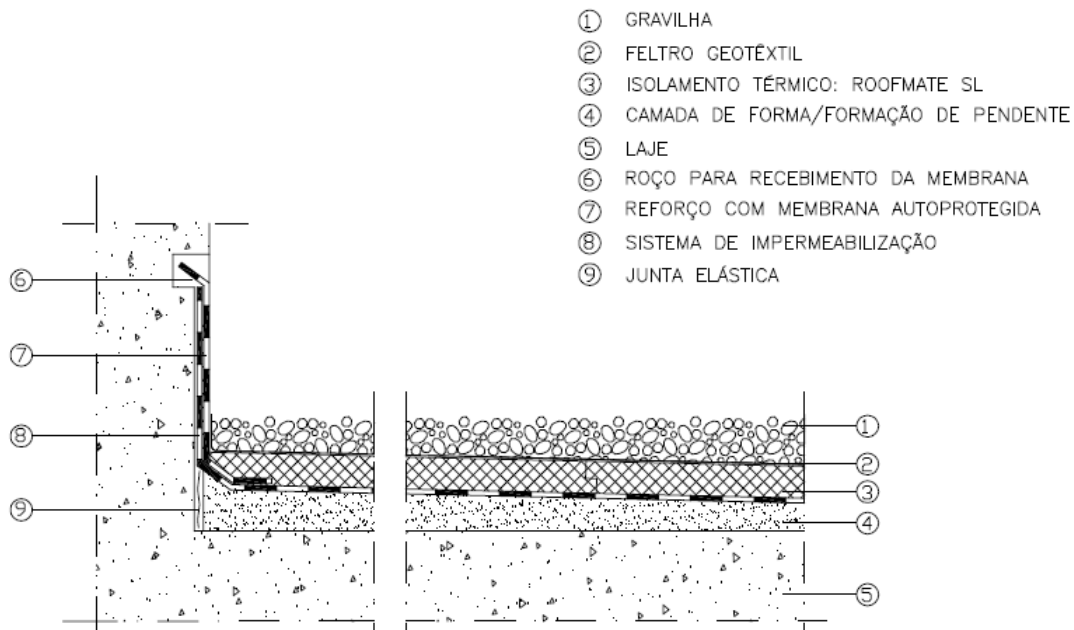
Constituição tipo de uma Cobertura Plana Invertida com pormenor de remate na zona da platibanda (Carlos Pereira, 2011)
